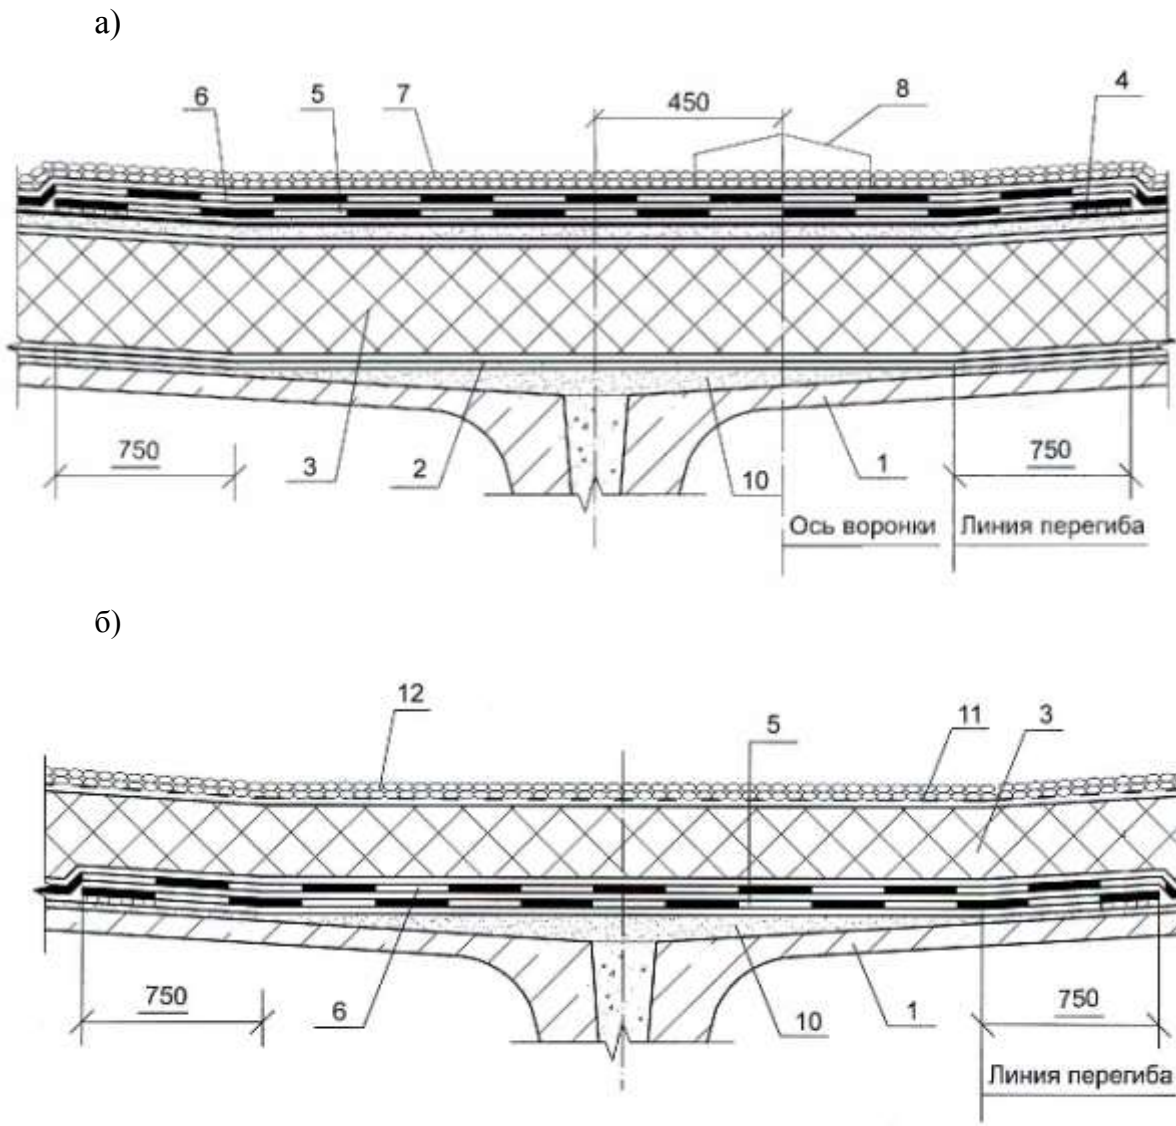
Ендова кровли а) традиционного; б) инверсионного покрытия.
